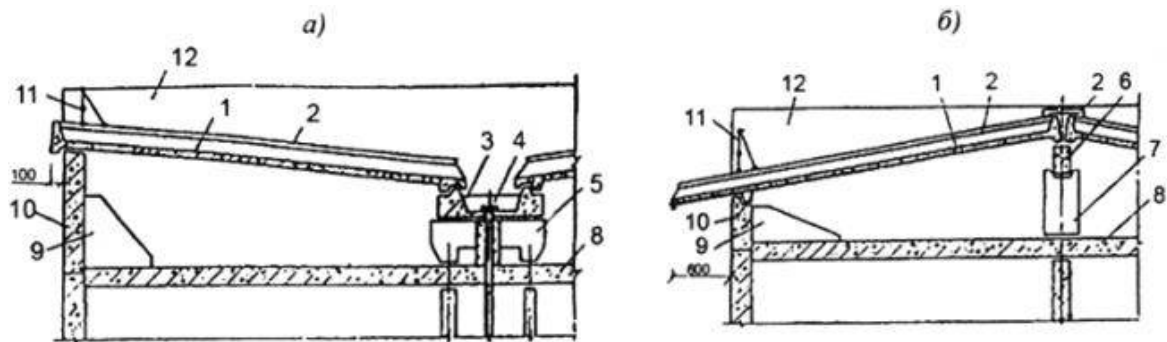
Конструктивные схемы кровель из железобетонных лотковых панелей:
